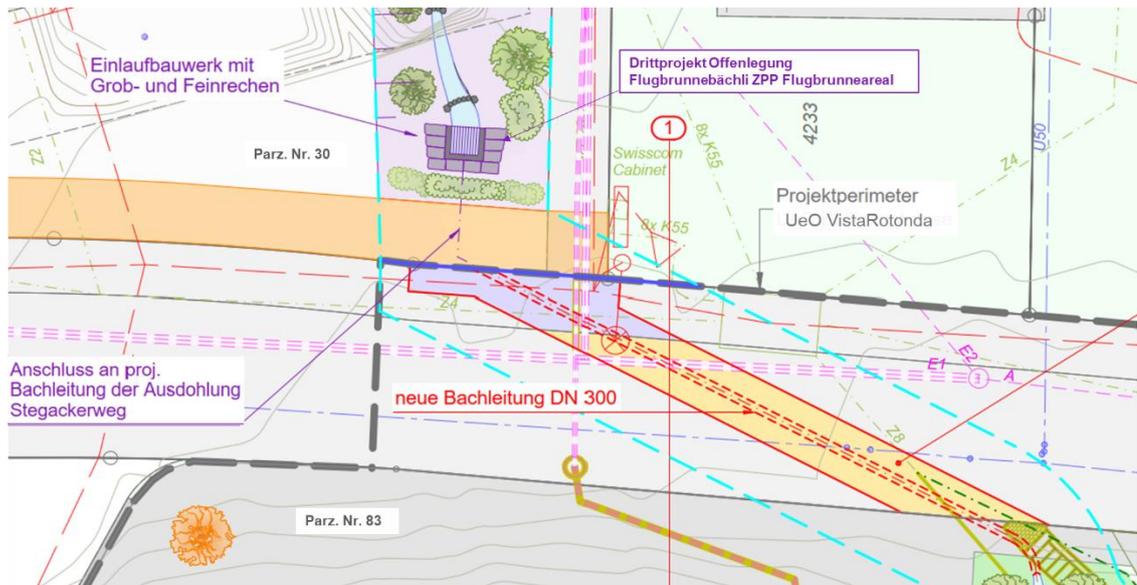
Ausschnitt aus Situationsplan: Detailansicht Fassung ab Einlaufbauwerk Stegackerweg
